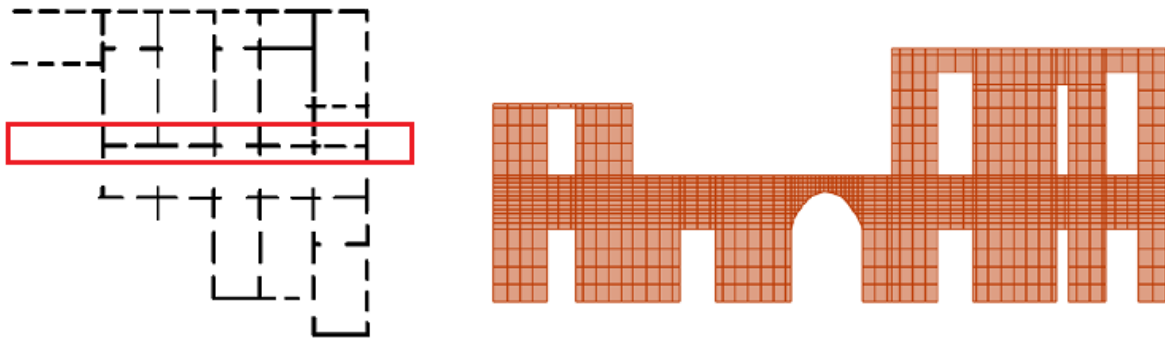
Izquierda: Planta del primer piso del Palacio Pereira. Derecha: Discretización empleada en muro de galería central
